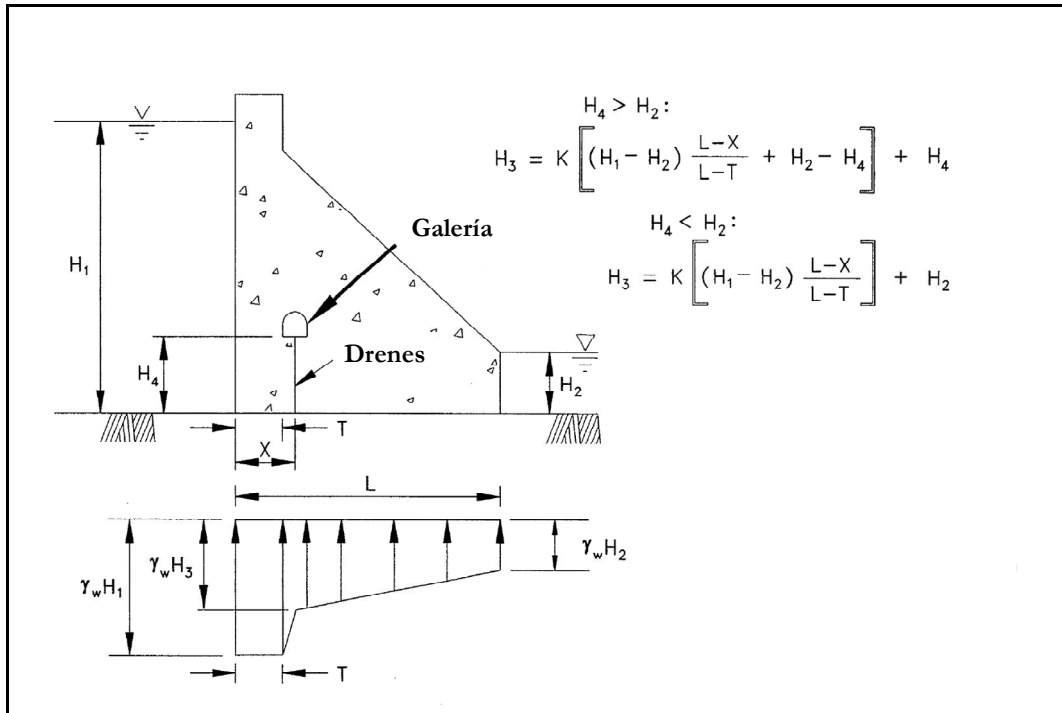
Ley de subpresiones. Caso estático, con pantalla de drenaje. Con grieta bajo del pie de aguas arriba sin alcanzar el plano de drenes. (Fuente: USACE [136]).
